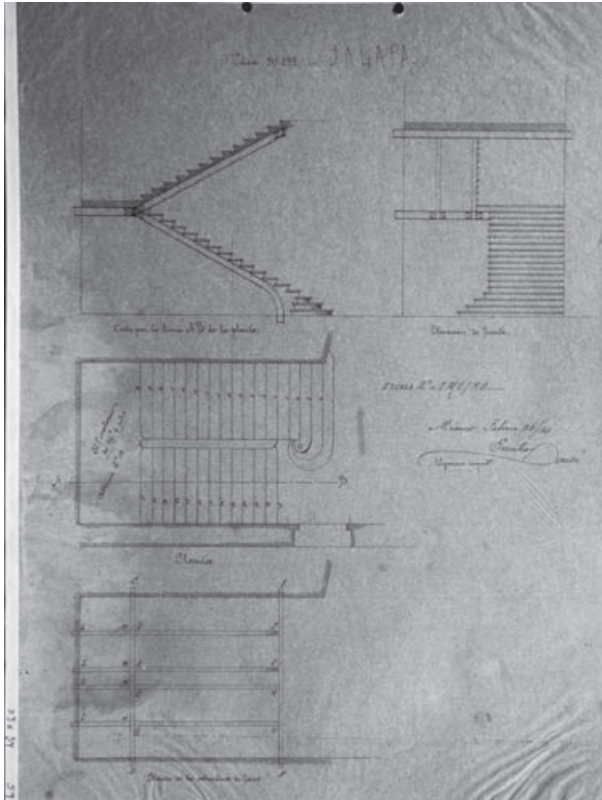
Planta de la estructura de hierro para escalera. AGJE, CNMHNAH, Donaciones-Emilio Dondé, leg. I, caja, 1, "Gran Hotel, Jalapa", 1893, plano 59.
